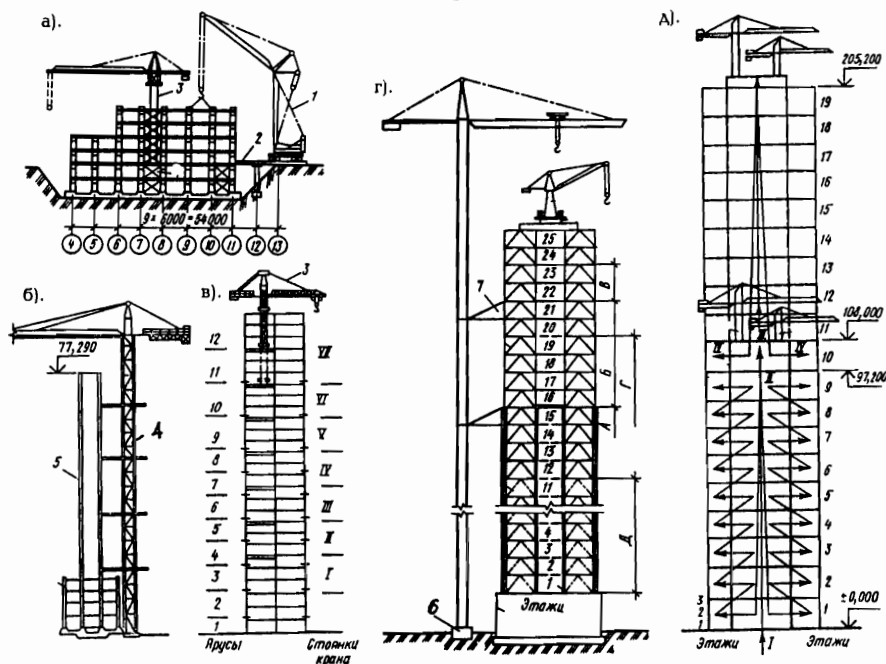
Принципиальные схемы размещения монтажных кранов при возведении зданий повышенной этажности: а – самоподъемного и стрелового крана; б – приставного крана, закрепляемого к ядру жесткости; в – самоподъемного крана; г) – самоподъемного и приставного крана; д – самоподъемных кранов; 1 – башенно-стреловой кран; 2 – эстакада; 3 – самоподъемный кран; 4 – приставной кран; 5 – ядер жесткости; 6 – фундамент приставного крана; 7 – связи
